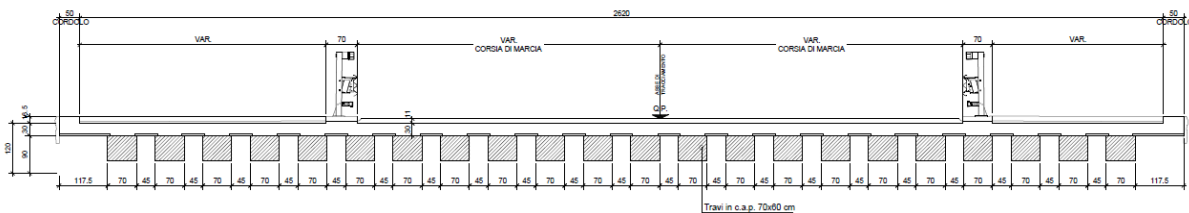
Sezione impalcato Ponte sul Canale di Cento 1
